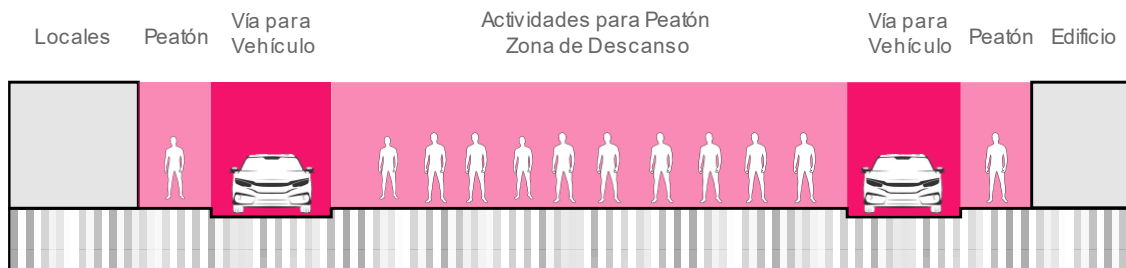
Barcelona Las Ramblas (HCC Hotels, 2021)
